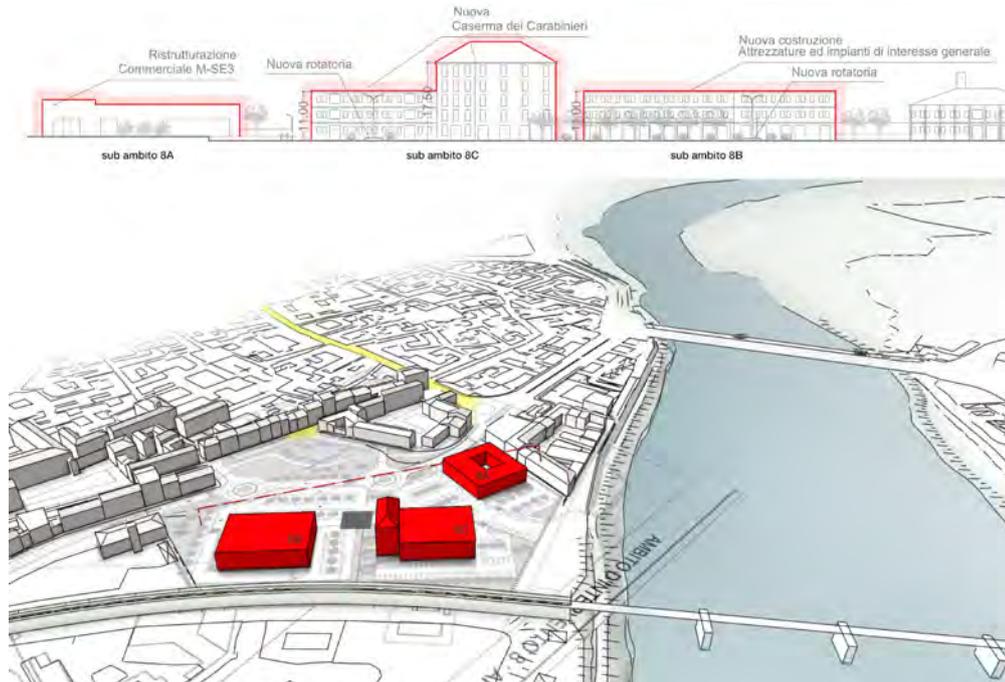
Vista d'insieme della soluzione PRGC (in rosso), rispetto al paesaggio fluviale. In alto, il prospetto mostra come lo skyline della riedificazione a ridosso delle sponde interrompa il rapporto con gli elementi del paesaggio e con il potenziale sistema delle aree verdi del territorio comunale, Repetti B.
